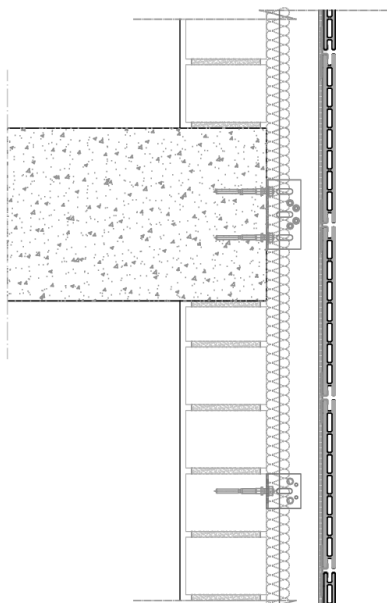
Sección vertical. Faveton® SAH Acqua 20-H.
